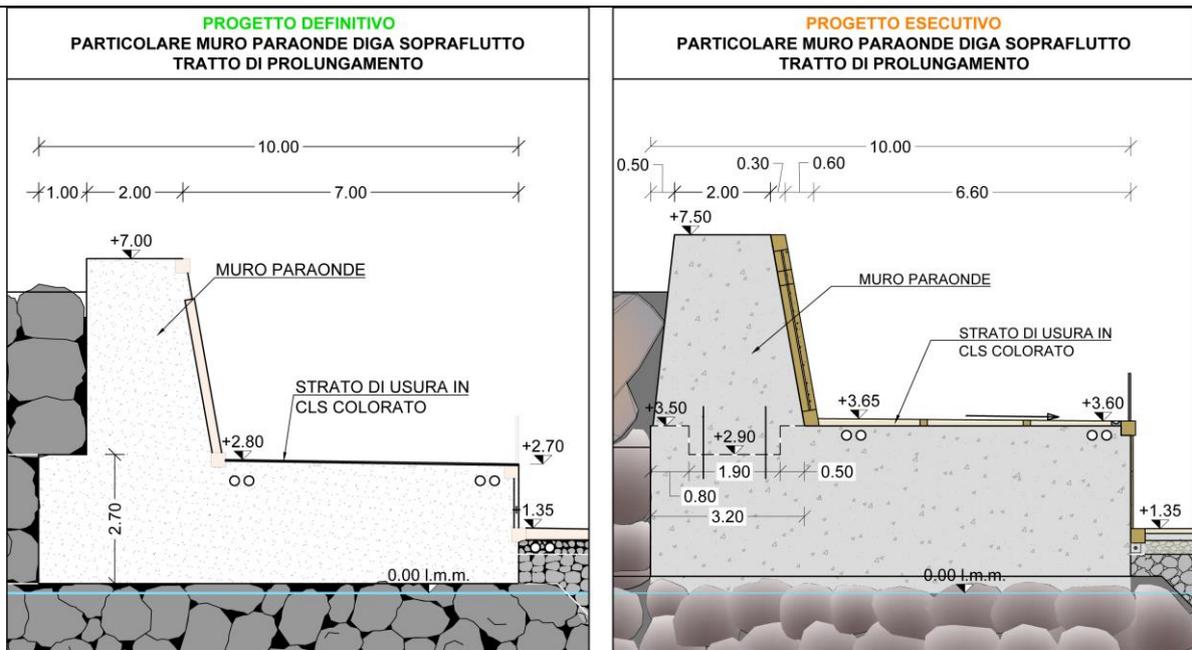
Particolare raffronto sezione muro paraonde P.D. e P.E.
